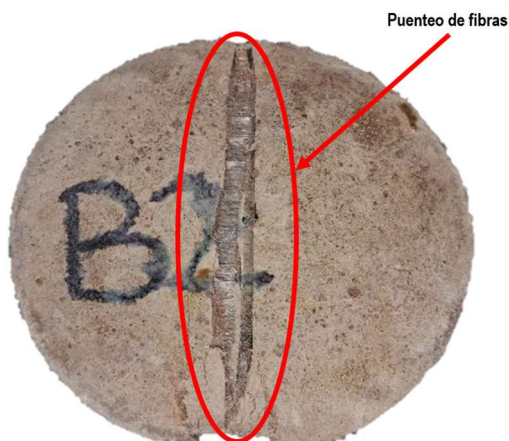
Puenteo de fibras tras la fisuración en ensayo de tracción indirecta.
